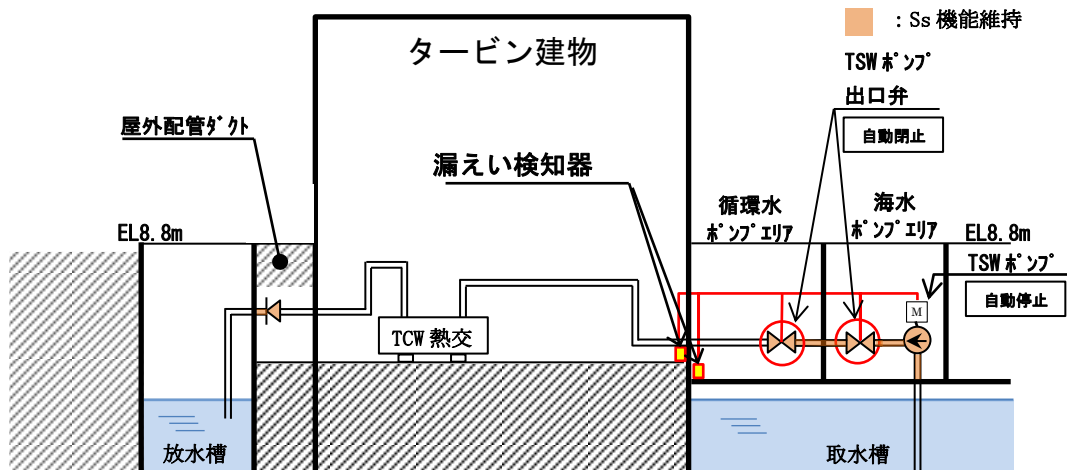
タービン補機海水系の対策概要 (断面図)
